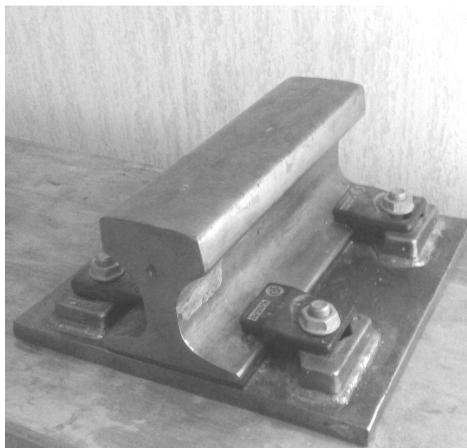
Крепление рельса к верхнему поясу подкрановой балки
